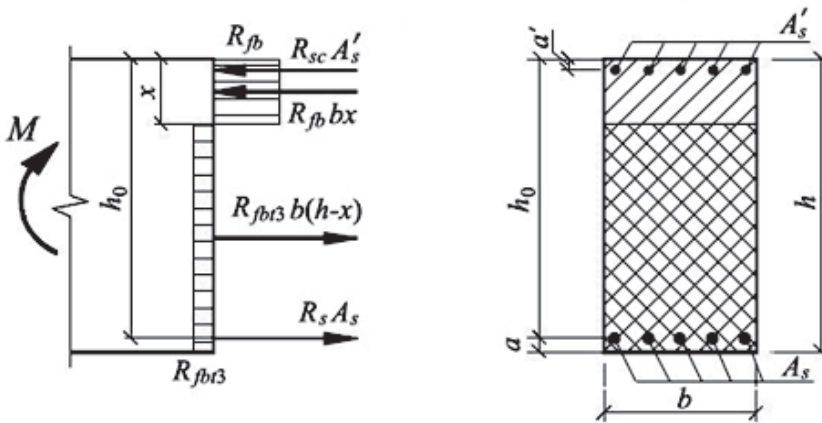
Схема усилий и эпюра напряжений в сечении, нормальном к продольной оси, при расчете по прочности изгибаемого сталефибробетонного элемента прямоугольного сечения с арматурой
